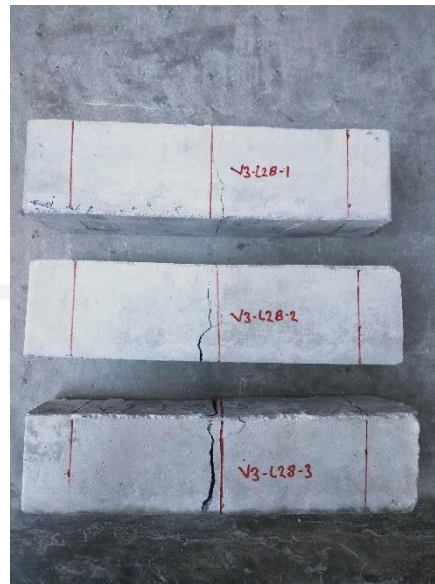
Hasil Pengujian Kuat Tarik Beton
